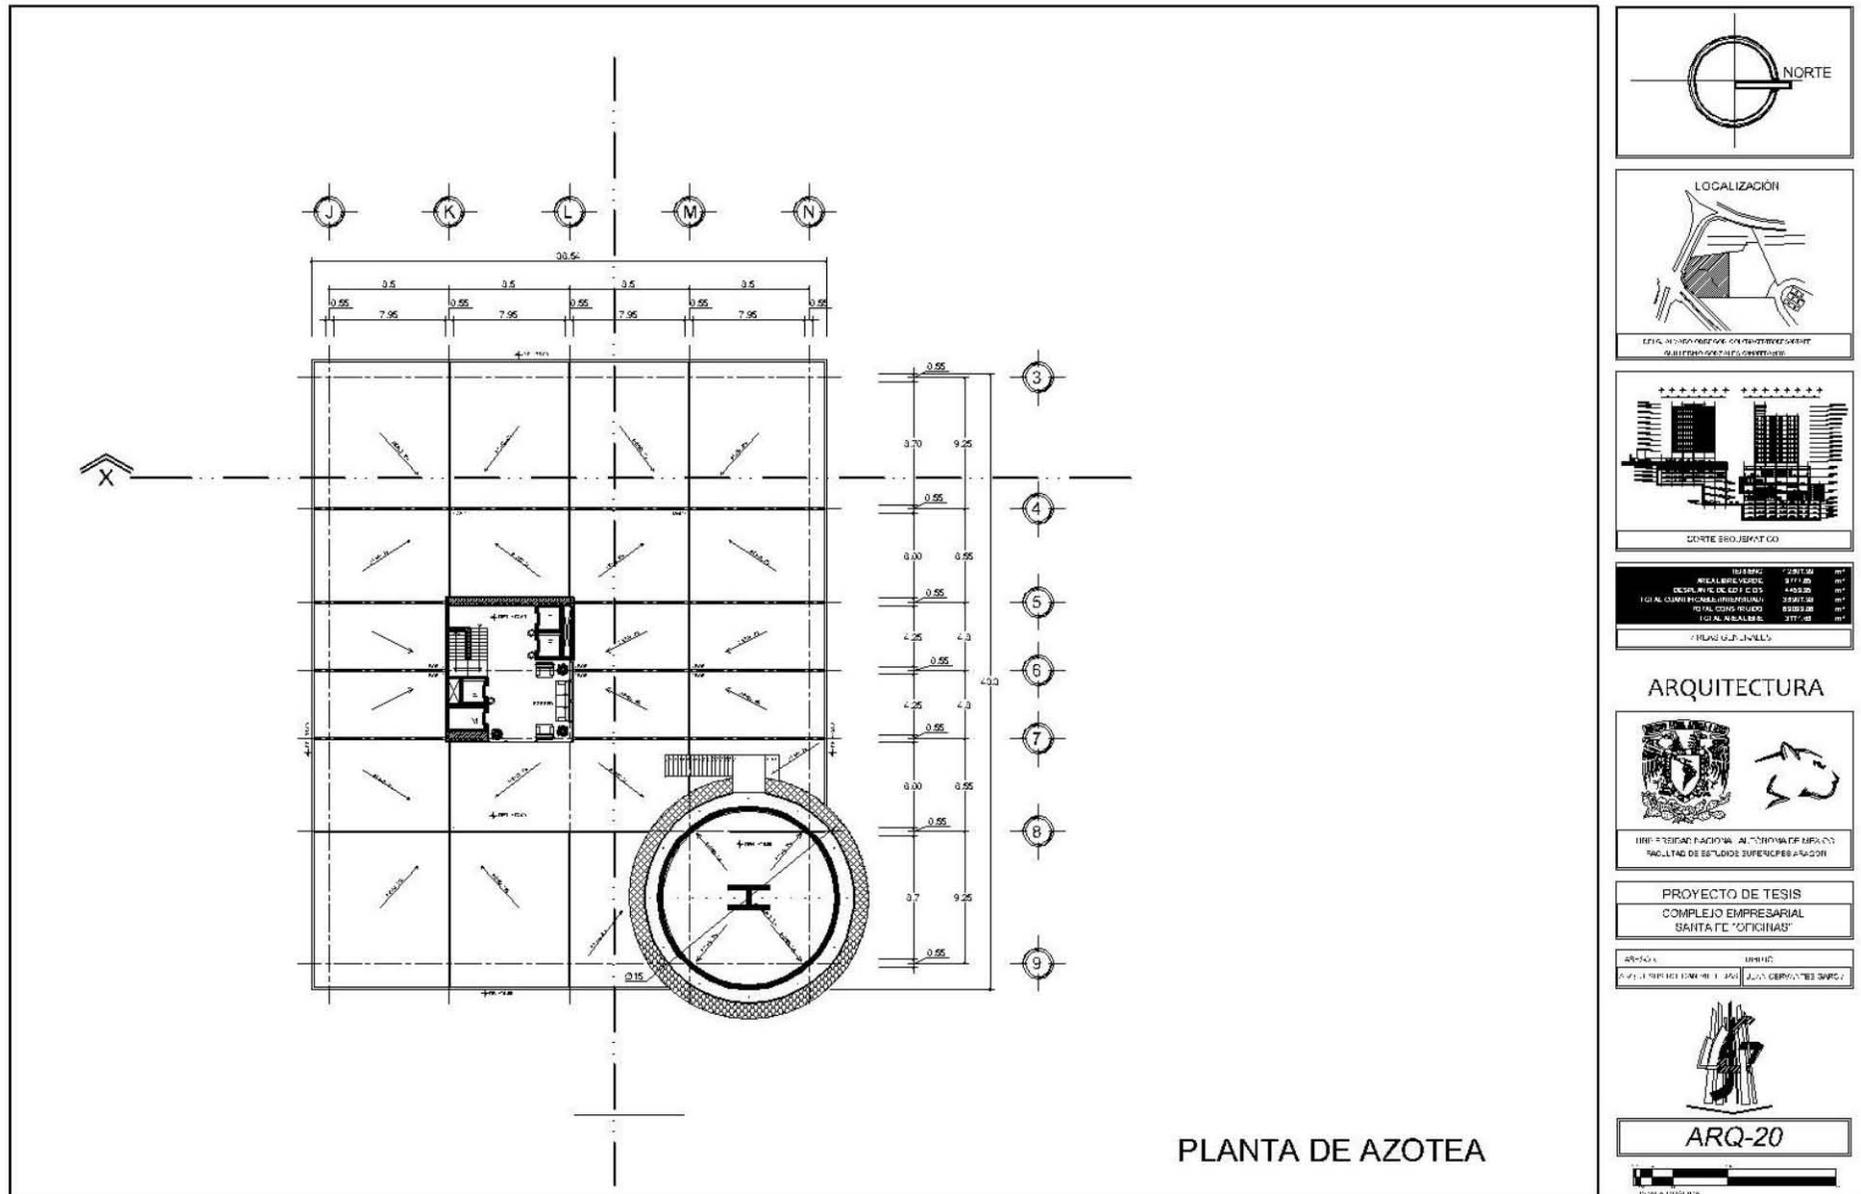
Plano ARQ-20; Planta Azotea Helipuerto Oficinas. Edición propia.
